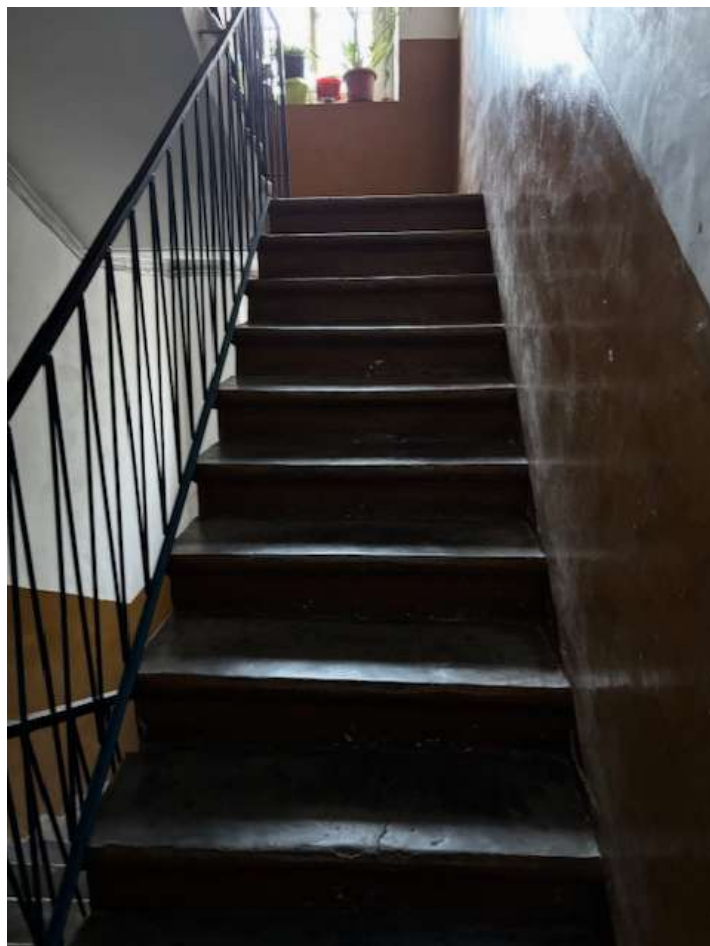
Scala d'accesso dal primo piano ai piani superiori
